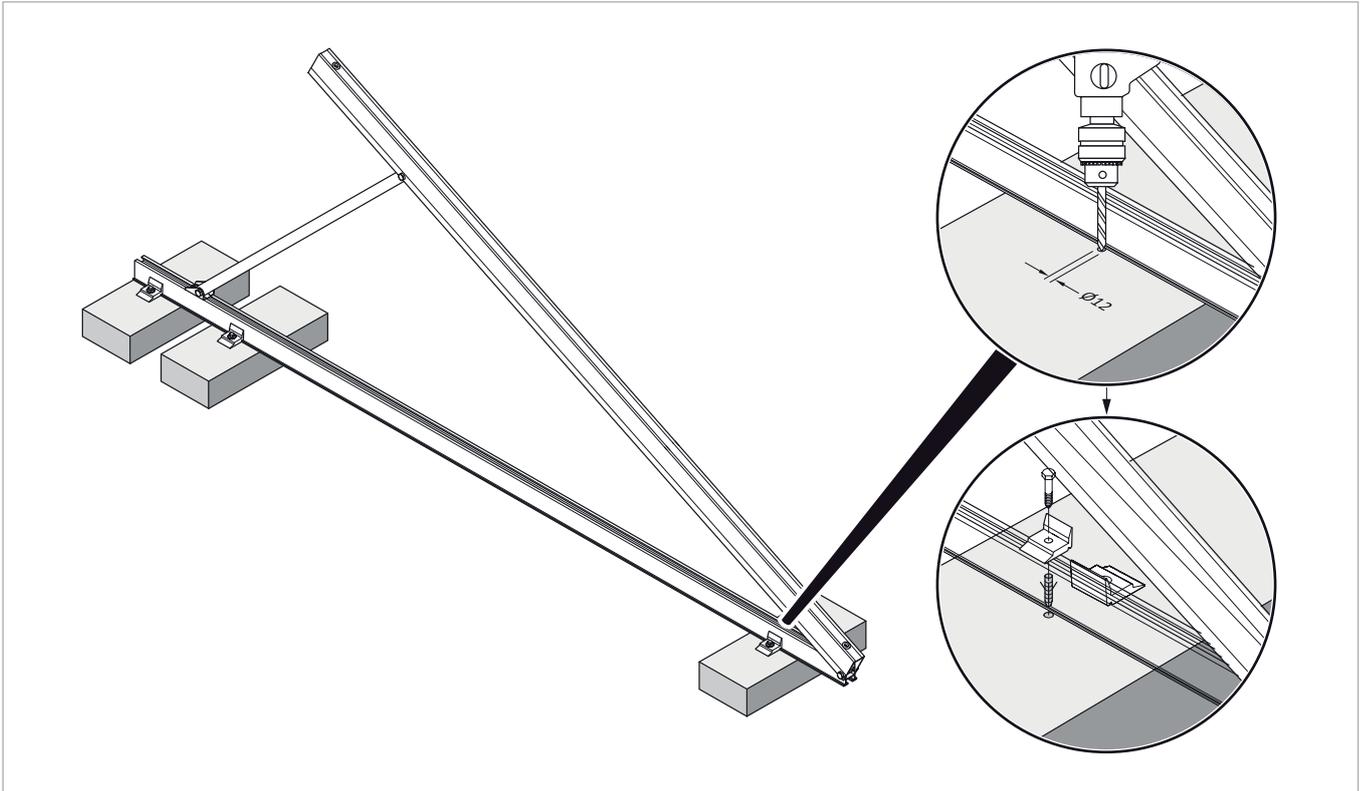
montaggio del supporto per tetto piano su blocco di calcestruzzo
